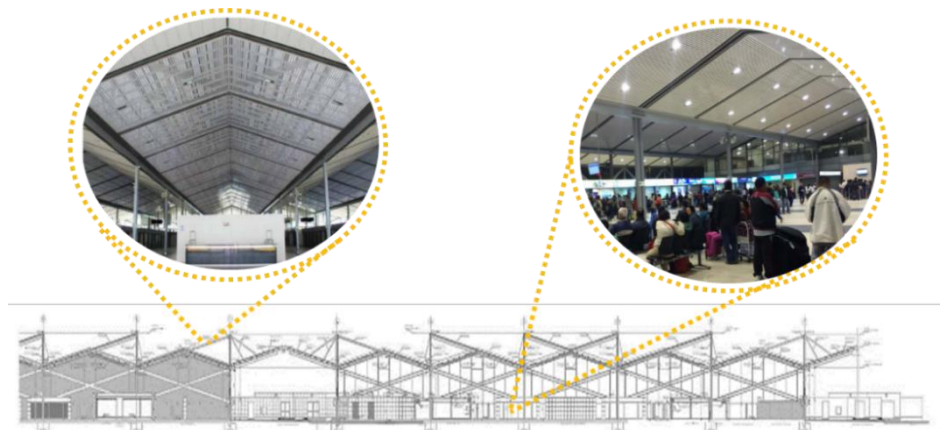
Corte constructivo del Terminal Terrestre de Trujillo
